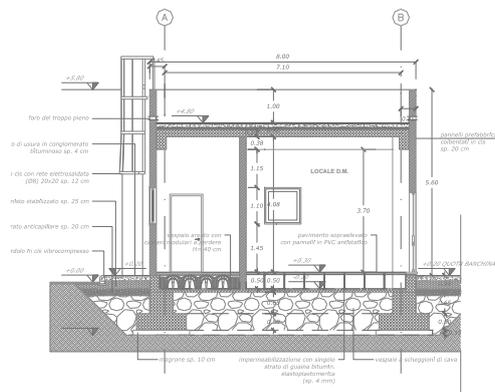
Sezione trasversale fabbricato tecnologico al km 5+483,124
